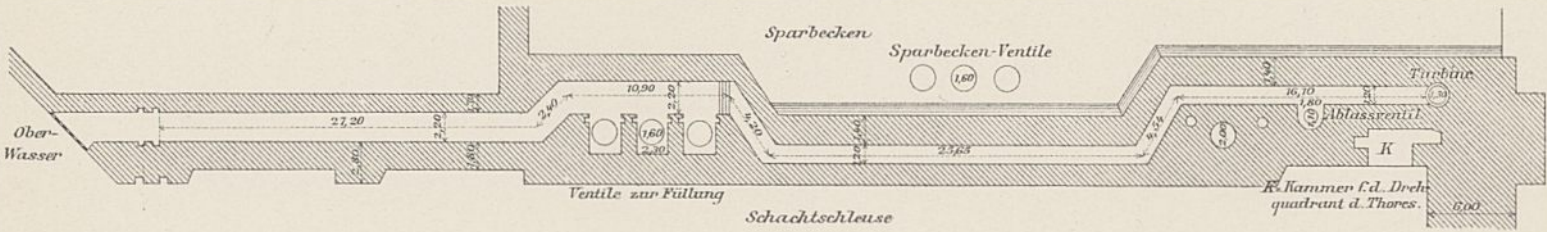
Grundriss des unteren Umlaufes.
